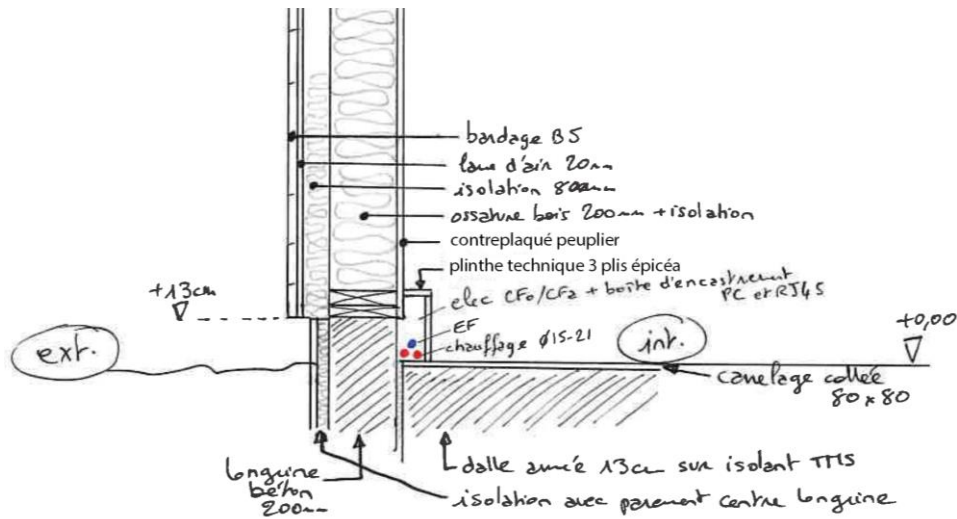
croquis détail en coupe du pied de mur de façades avec plinthe technique 3 plis épicea
